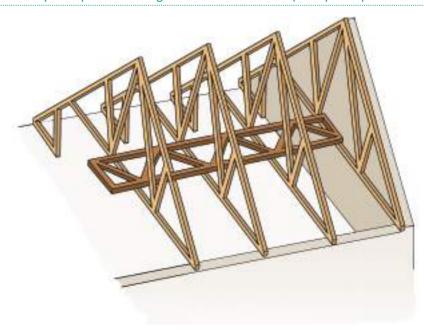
Dispositif pour rendre rigide une ferme boiteuse (exemple de poutre horizontale)
